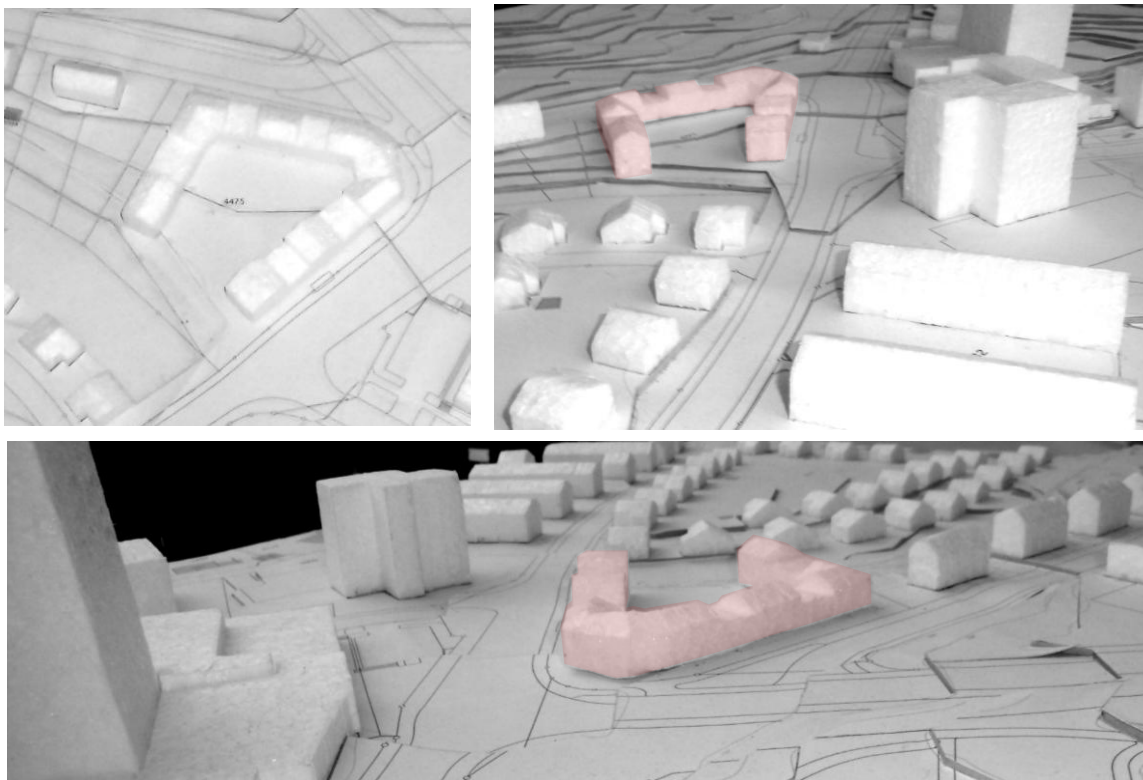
Modellfotos. möglicher Bebauung: Areal G: Alpenblick
